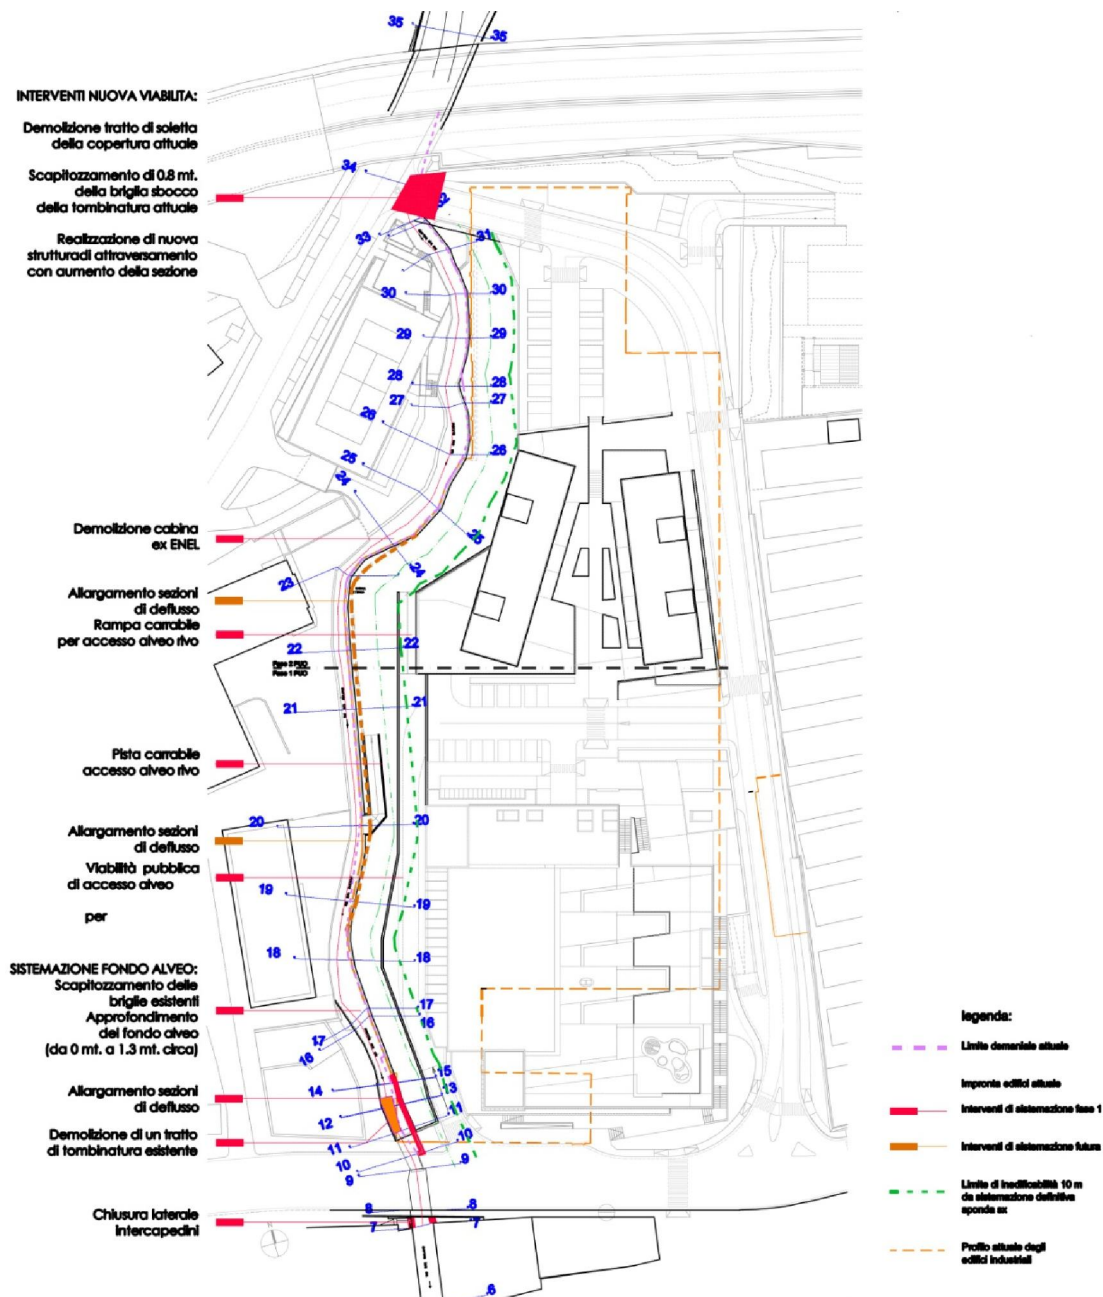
Planimetria interventi di sistemazione Idraulica Rio San Giuliano (da Rel. Compatibilità Idraulica)
